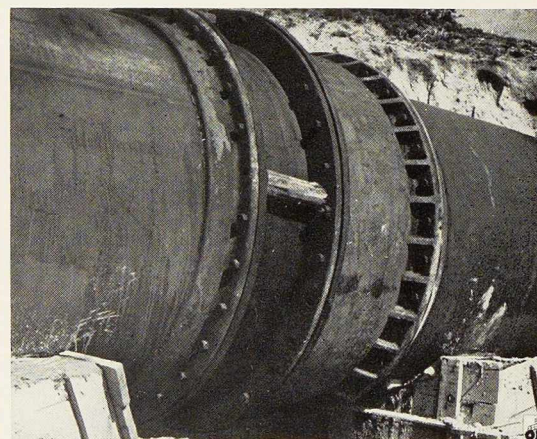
Joint de dilatation en acier coulé, soudé à la tuyauterie.
